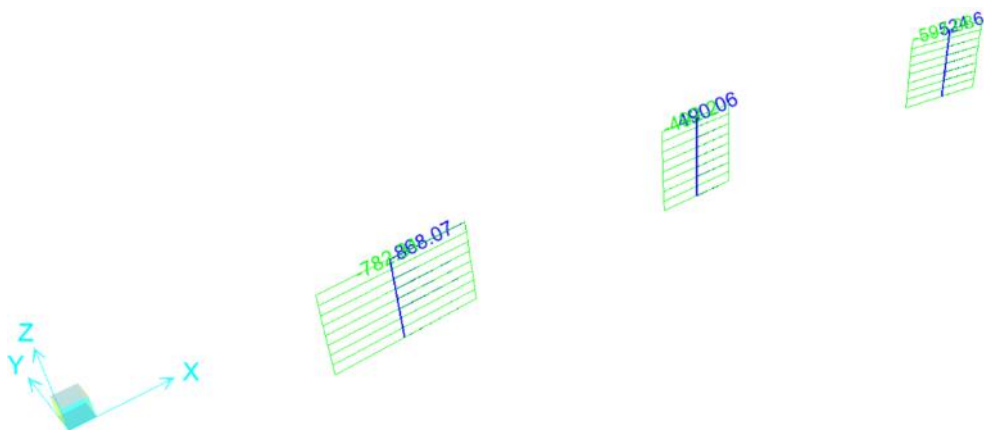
Diagrama cortante longitudinal (KN) de las columnas puente Vía a Minca
